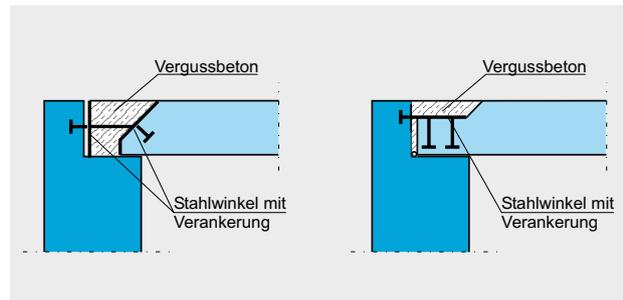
Wand-Decken-Knoten mit Stahlwinkel
